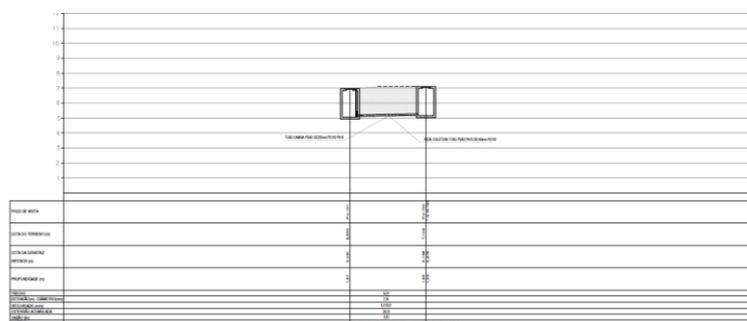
Perfil longitudinal da travessia SB-T02 - PV-130 ao PV-131
